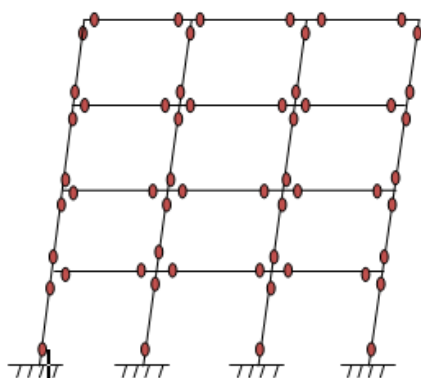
Rotules plastiques aux extrémités des poutres et poteaux
